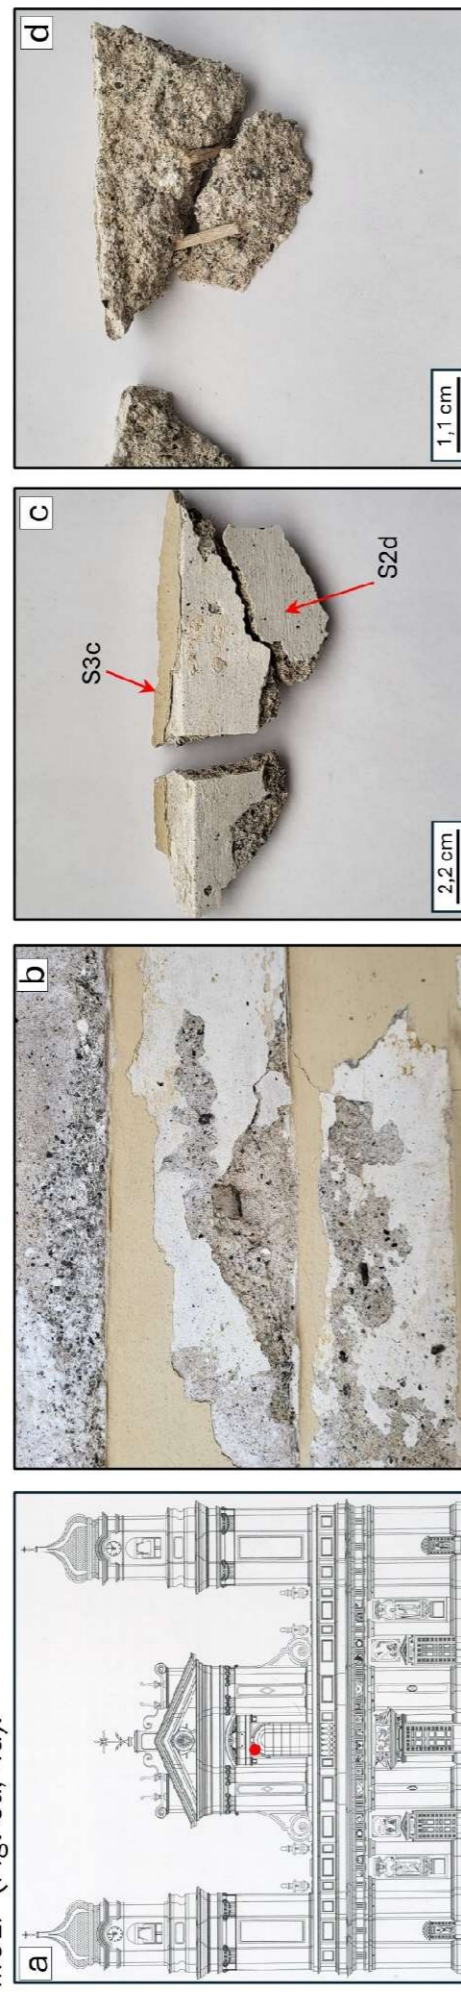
a) posizione campione nel prospetto principale della Basilica; b) punto di prelievo del campione nella sezione del muro; c) campione C3A (vista dall'alto); e) campione C3A (vista dal basso).
